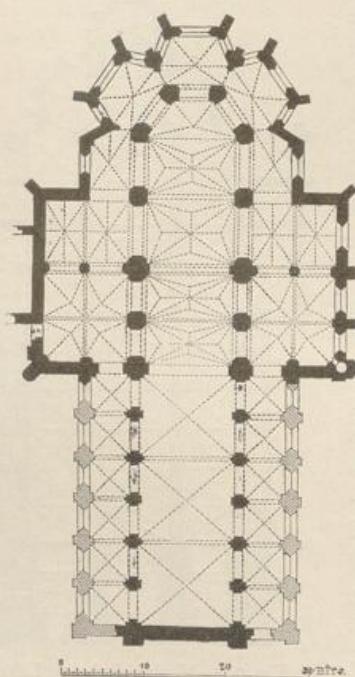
Grundriss von Dargun. (Nach Dohme.)
